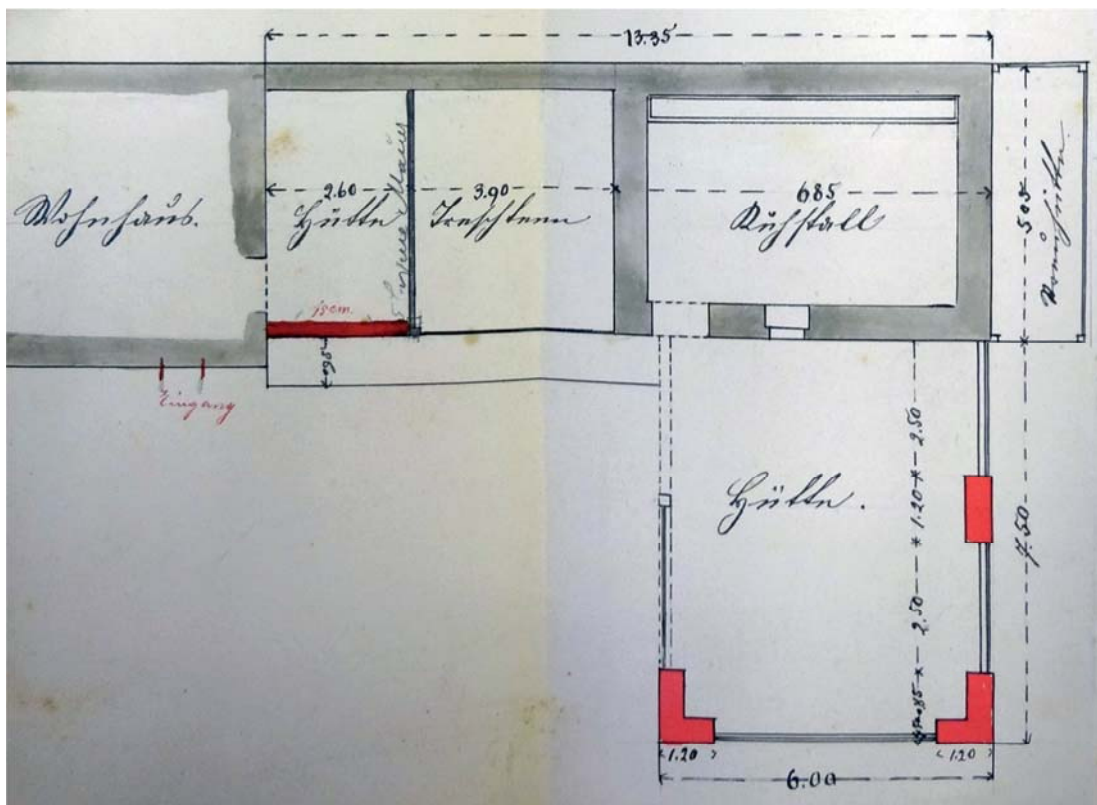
Grundriss (gewestet) des Wirtschaftsbereiches und Teil des Wohnhauses
